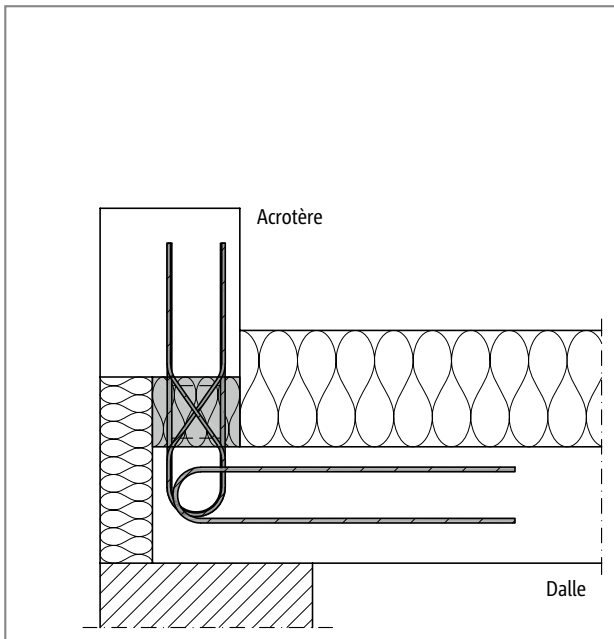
Schöck Isokorb® T Type A : Raccordement sur acrotère (Type A-MM1-VV1)
